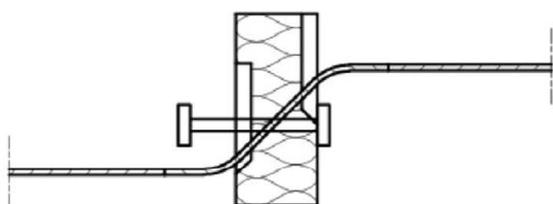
Schöck Isokorb® Typ K-ID mit
